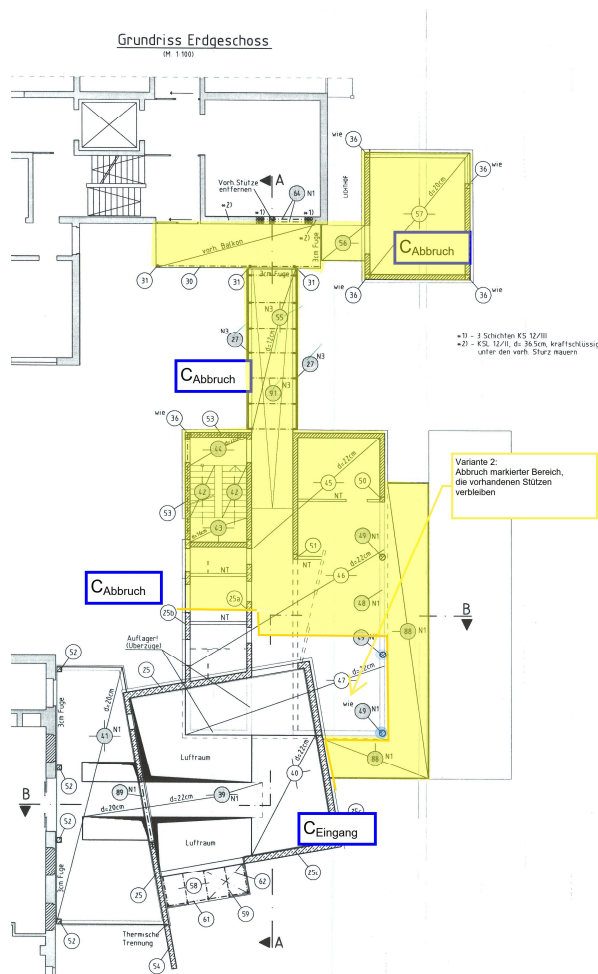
Auszug aus dem Positionsplan Erdgeschoss P3b vom 24.02.2003
